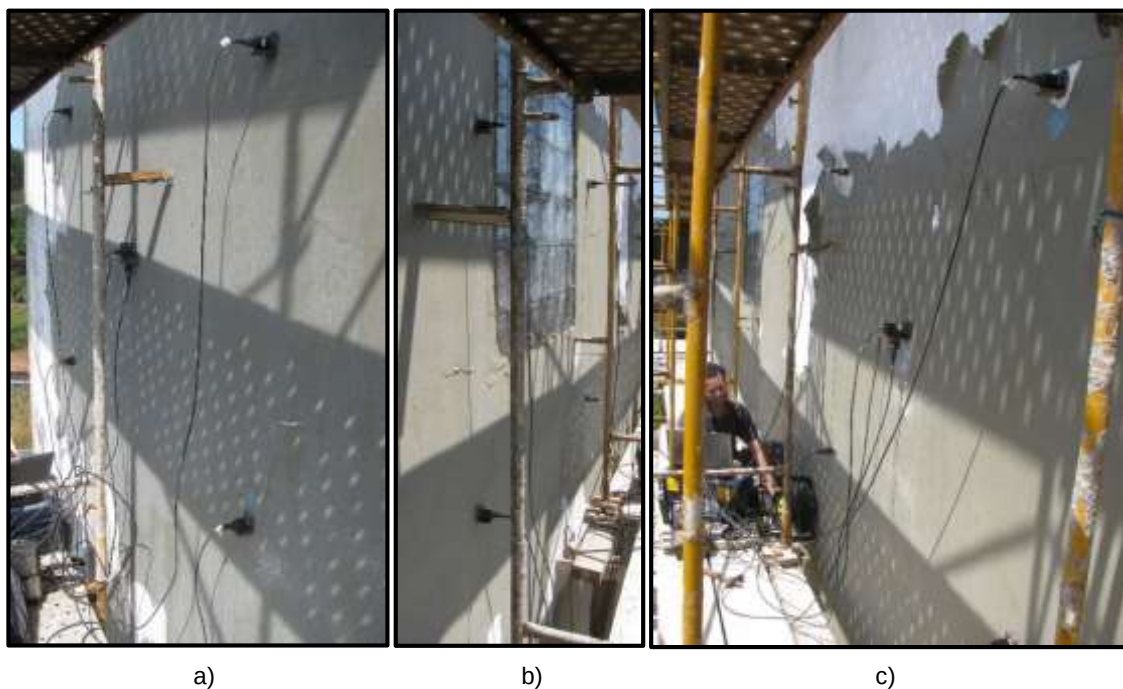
Instrumentação completa utilizada no ensaio; (a) Parede 1; (b) Parede 2; (c) Parede 3.
